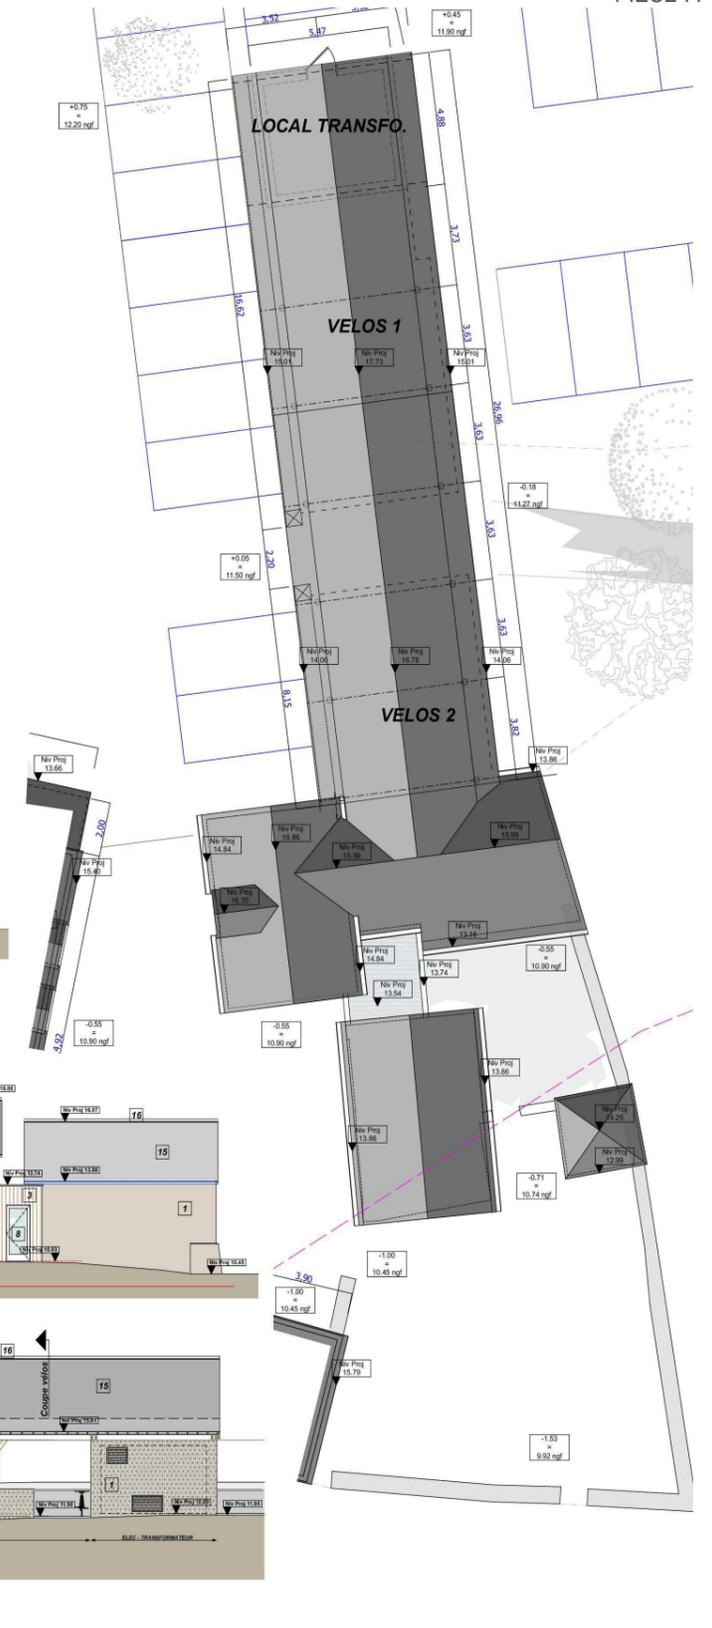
Plan masse Laënnec/La Voilerie (Source : Paumier Architectes Associés)
